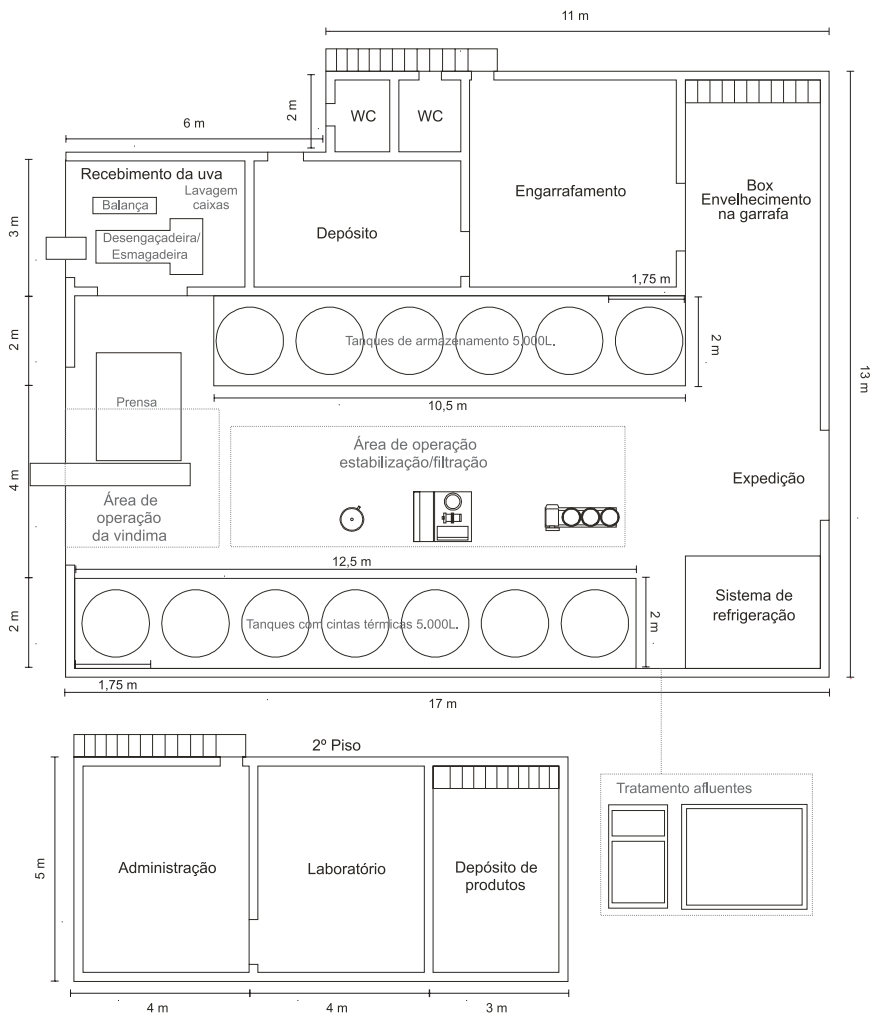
Planta baixa da agroindústria (cantina) para elaboração de vinho.
